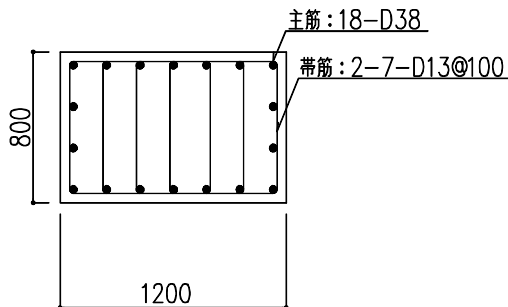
柱の配筋図 (地下2階, X3/YF 通り, 柱脚部) (単位: mm)
